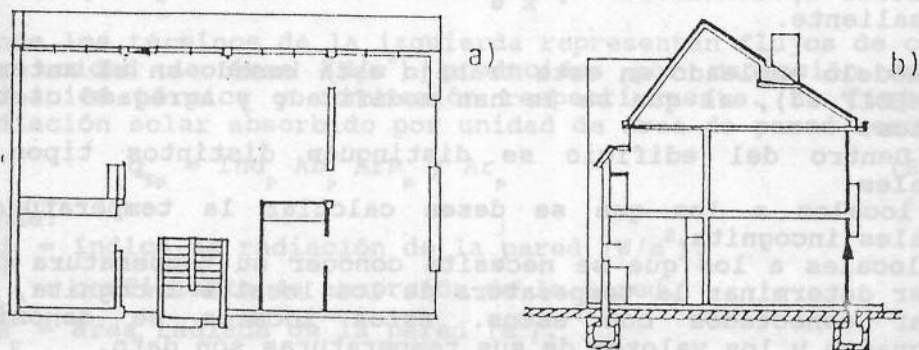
Representación esquemática de la vivienda a) Planta baja investigada (Norte hacia arriba) y b) corte vertical (Norte hacia la derecha)
